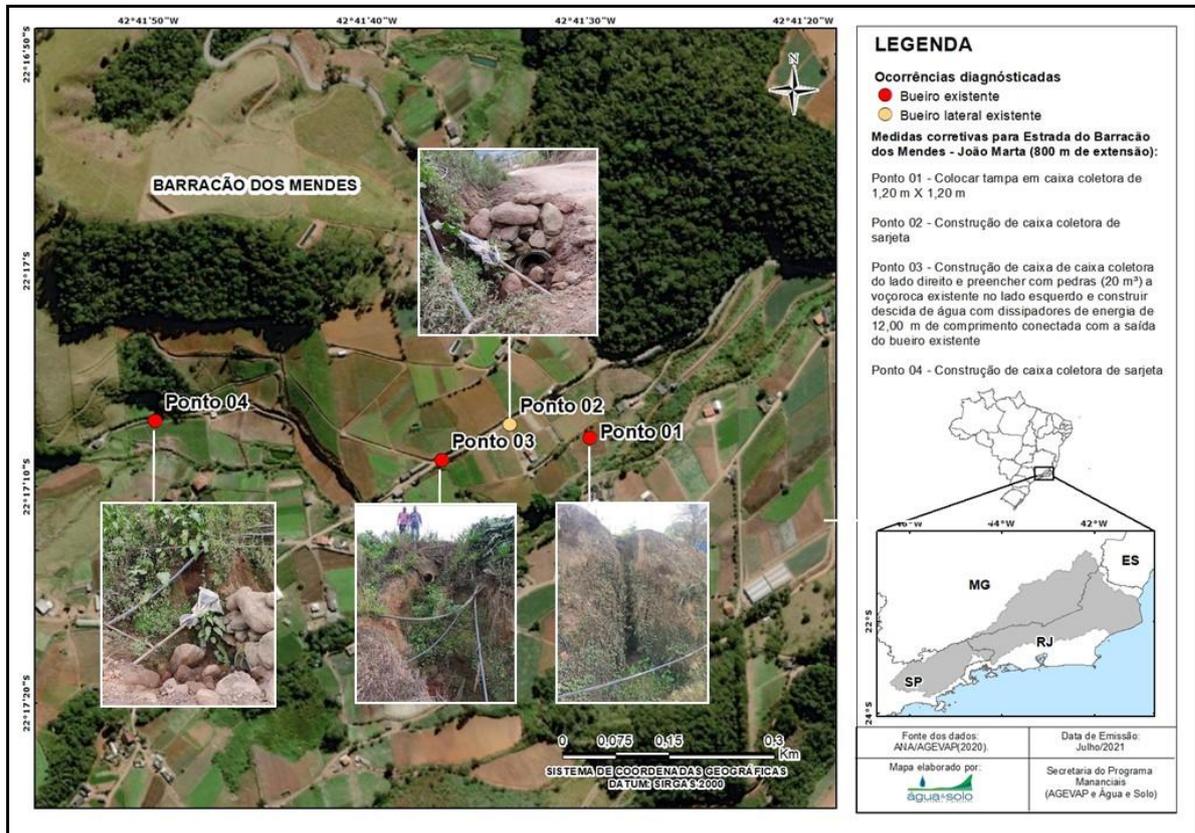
Locais para instalação de estruturas de drenagem – alinhamento 4
